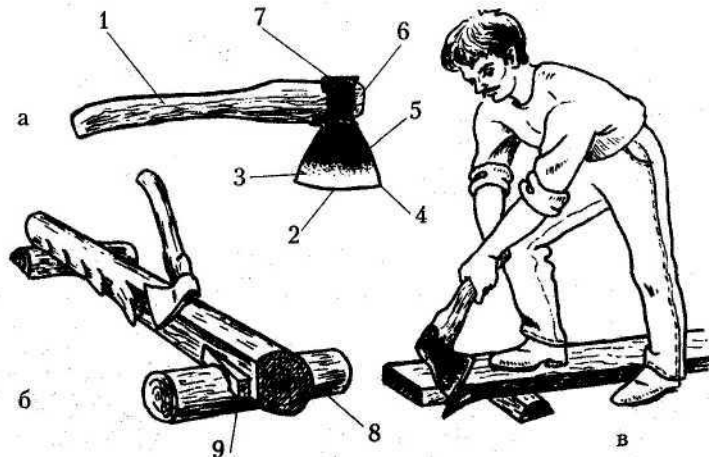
Русский плотничный топор и приемы работы: а — топор; б — теска бревна на подкладке; в — теска кромки доски; 1 — топориче (береза, ясень, клен, бук, вяз); 2 — лезвие; 3 — фаска; 4 — носок; 5 — щека; 6 — стальной распорный клин; 7 — обух; 8 — подкладка; 9 — деревянный клин
